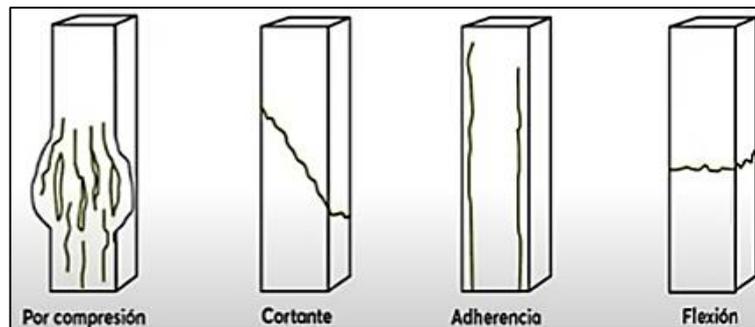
TIPO DE FALLAS EN COLUMNAS
